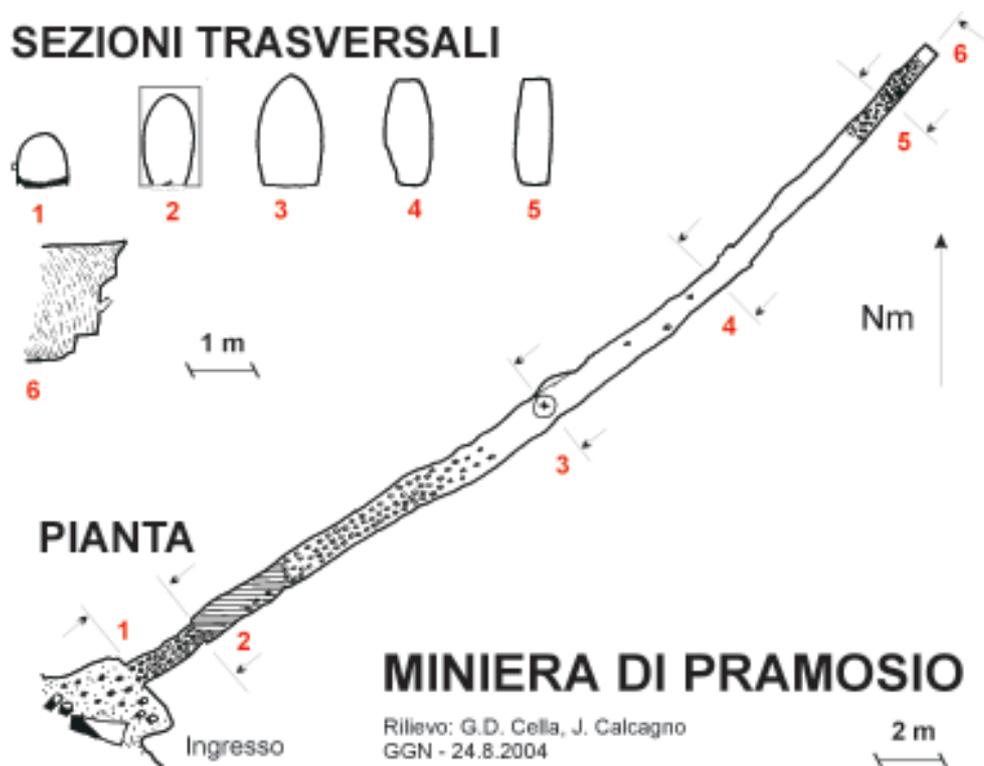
Planimetria e sezioni della miniera medioevale di Pramosio.
